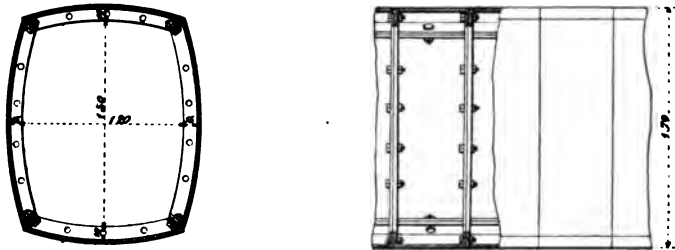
Coupes transversale et longitudinale du revêtement en fonte.
